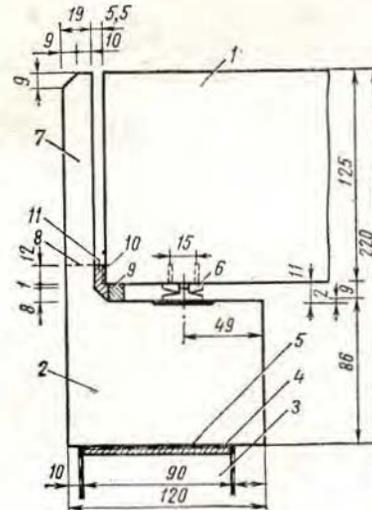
Схема опирания балки на обвязочную рандбалку. Описание:
